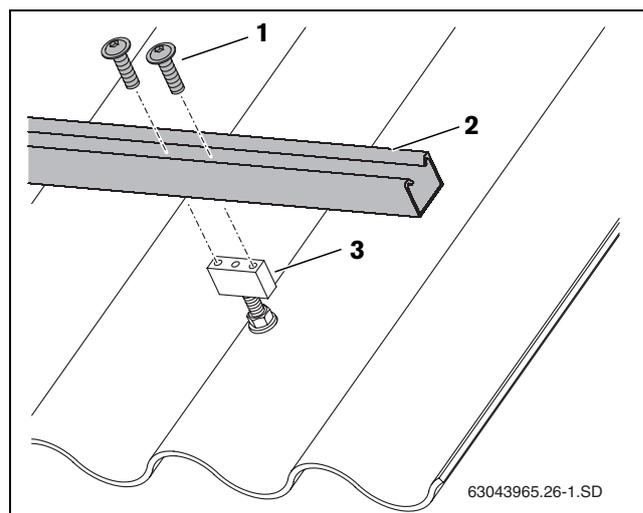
Fissaggio della guida profilata al blocco di fissaggio
